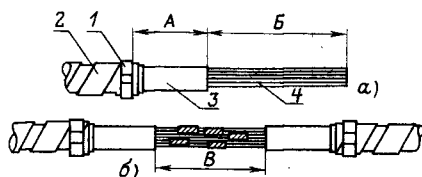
Подготовка кабеля к соединению: а — разделка концов кабеля; б — соединение жил кабеля; 1 — биндаж; 2 — ленточная броня; 3 — поливинилхлоридная или резиновая оболочка; 4 — жилы кабеля
